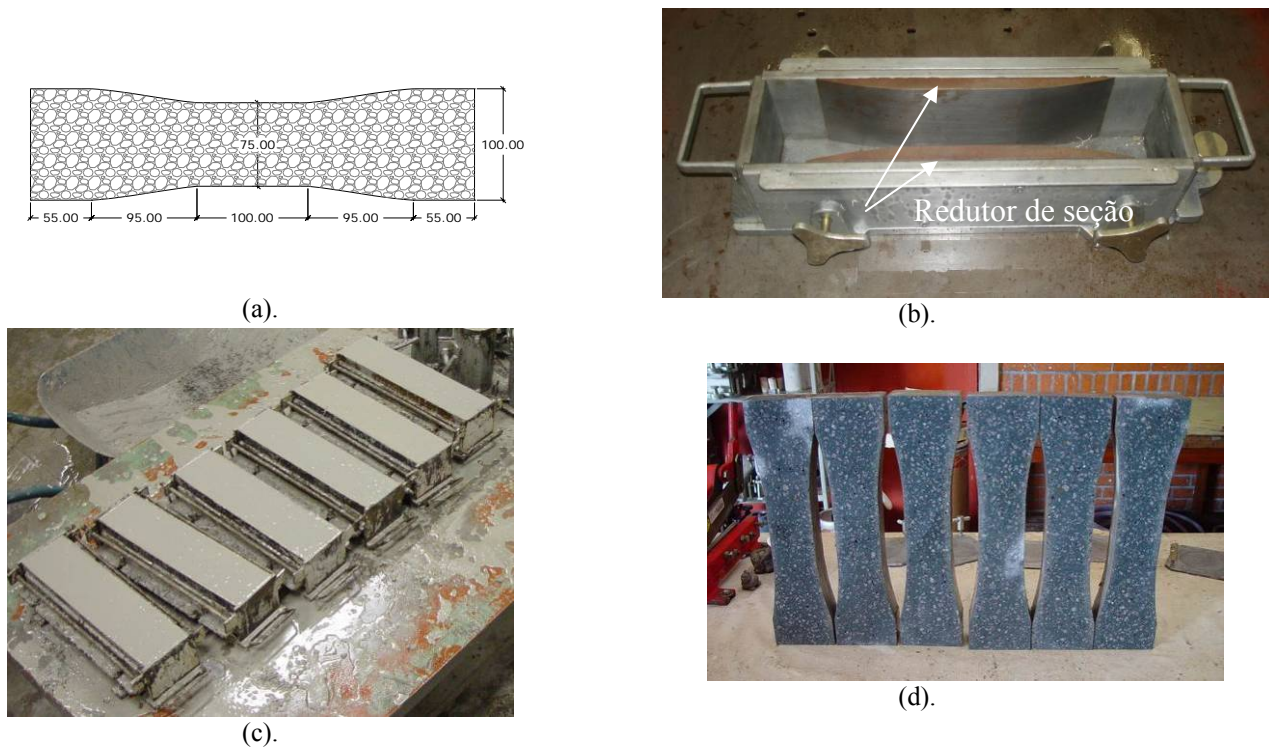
Tração direta: (a) dimensões das amostras; (b) molde com redutor de seção; (c) amostras moldadas; (d) amostras após cortadas através de serra diamantada.
